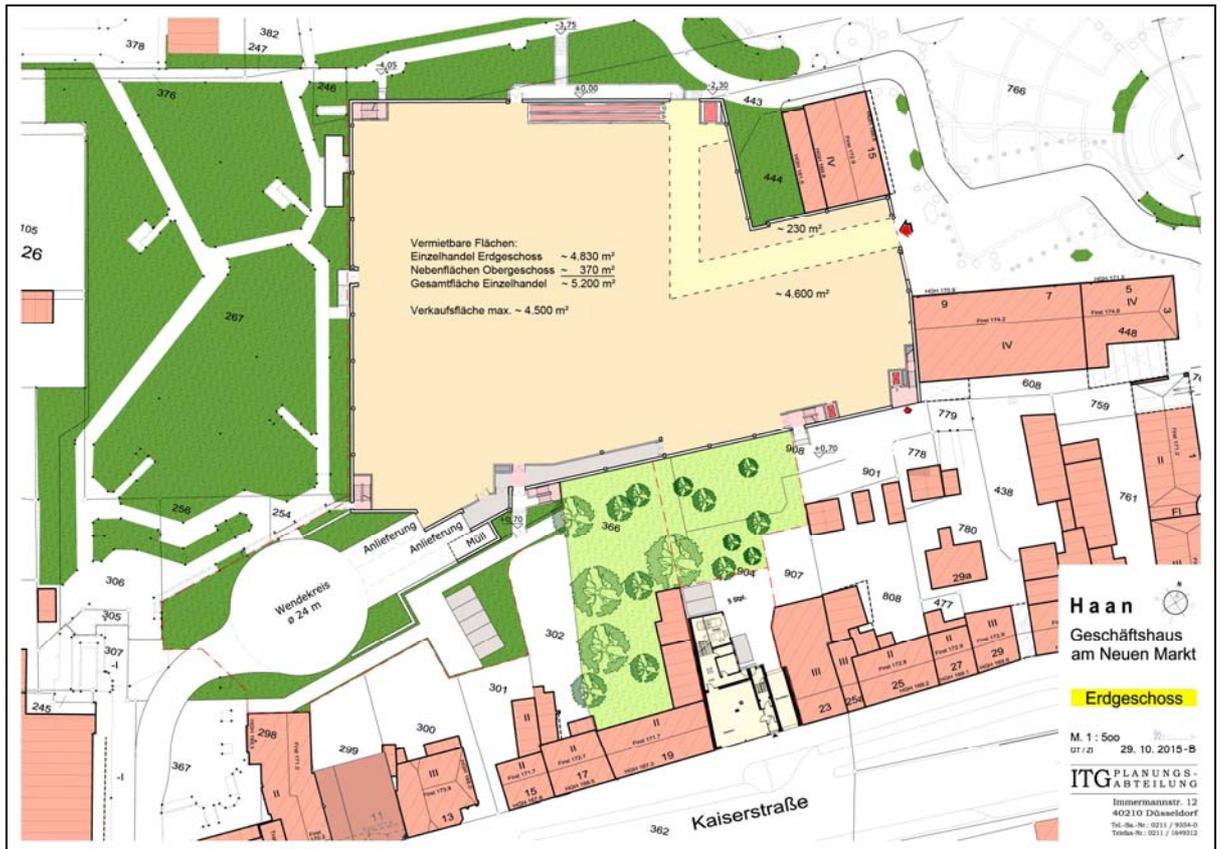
Übersichtslageplan EKZ Windhövel - Erdgeschosssebene (ITG Planungsabteilung, Stand 29.10.2015, ohne Maßstab)
